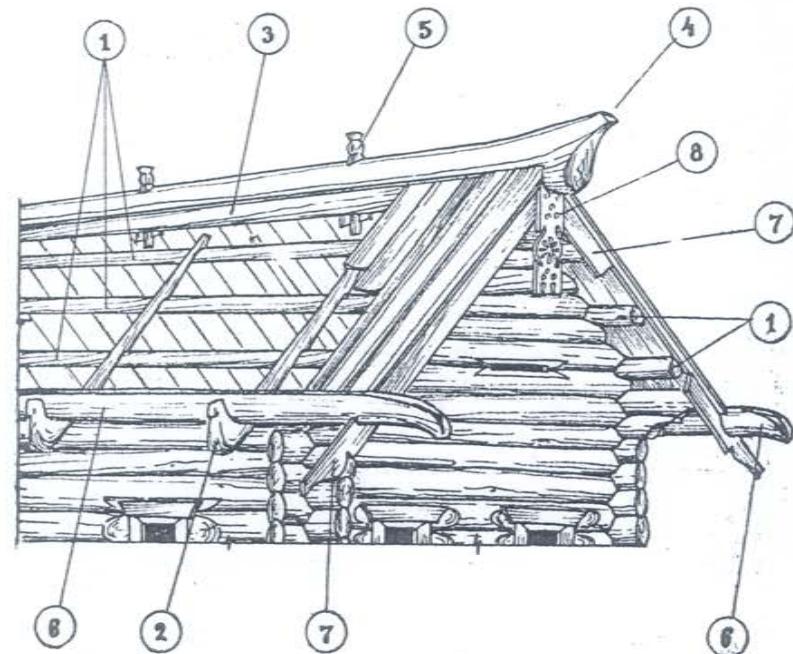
Рис. I. Схема устройства безгвоздевой двускатной кровли:
